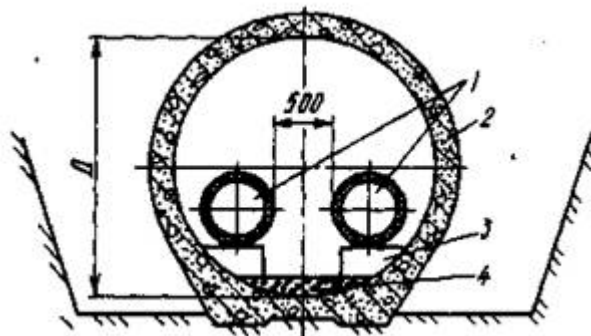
Канал круглого перерізу із залізобетонних труб (напівпрохідний):
